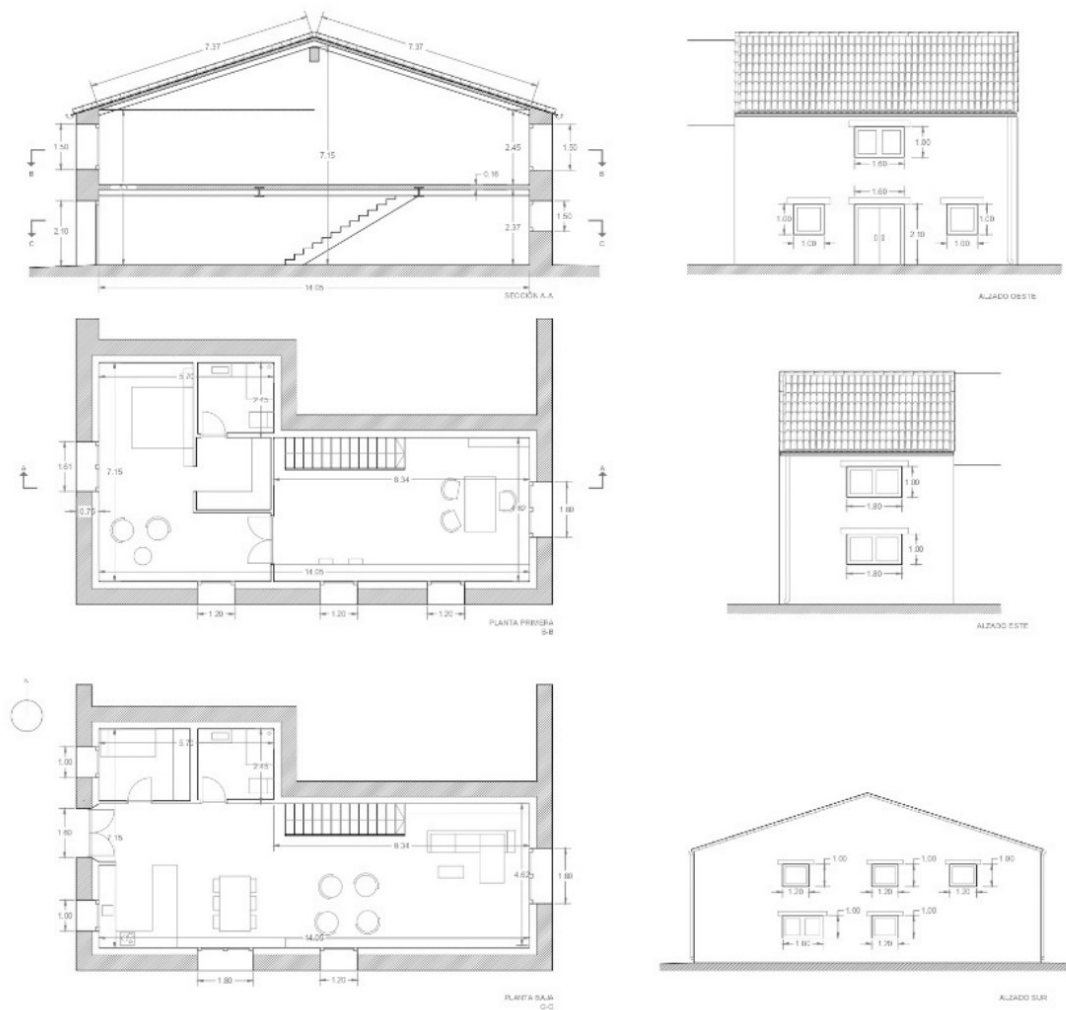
Planos Vivienda propuesta para el cálculo. Fuente: Elaboración propia
